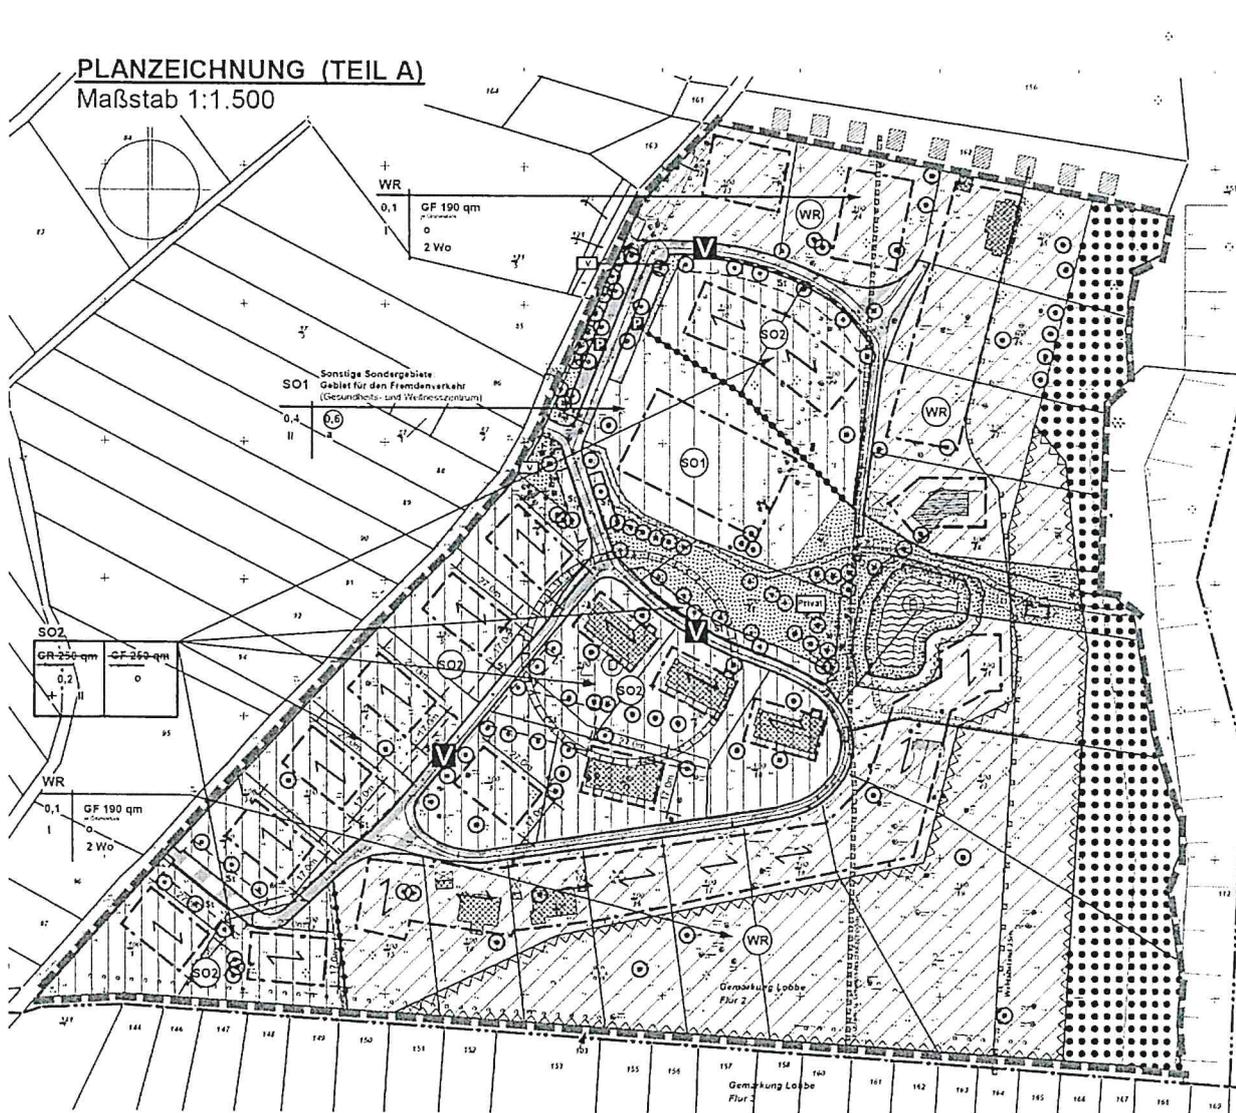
Planzeichnung (Teil A), Stand 5. Änderung (unmaßstäbliche Verkleinerung)
